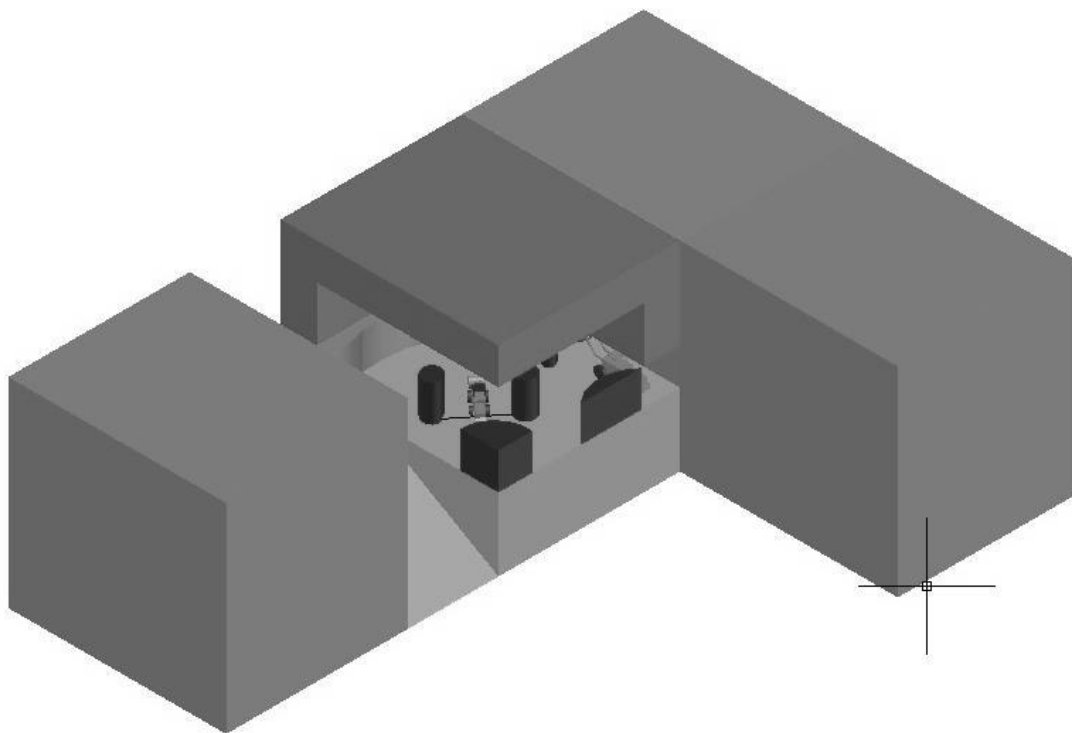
Extracción por cámaras y pilares. Fuente: Diseño del Autor
